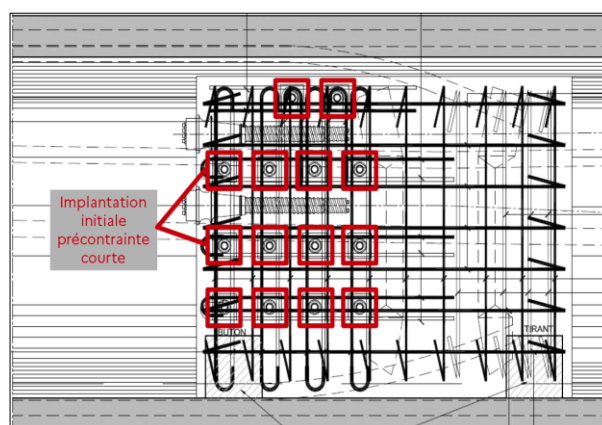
Implantation de la précontrainte et du ferrailage passif
